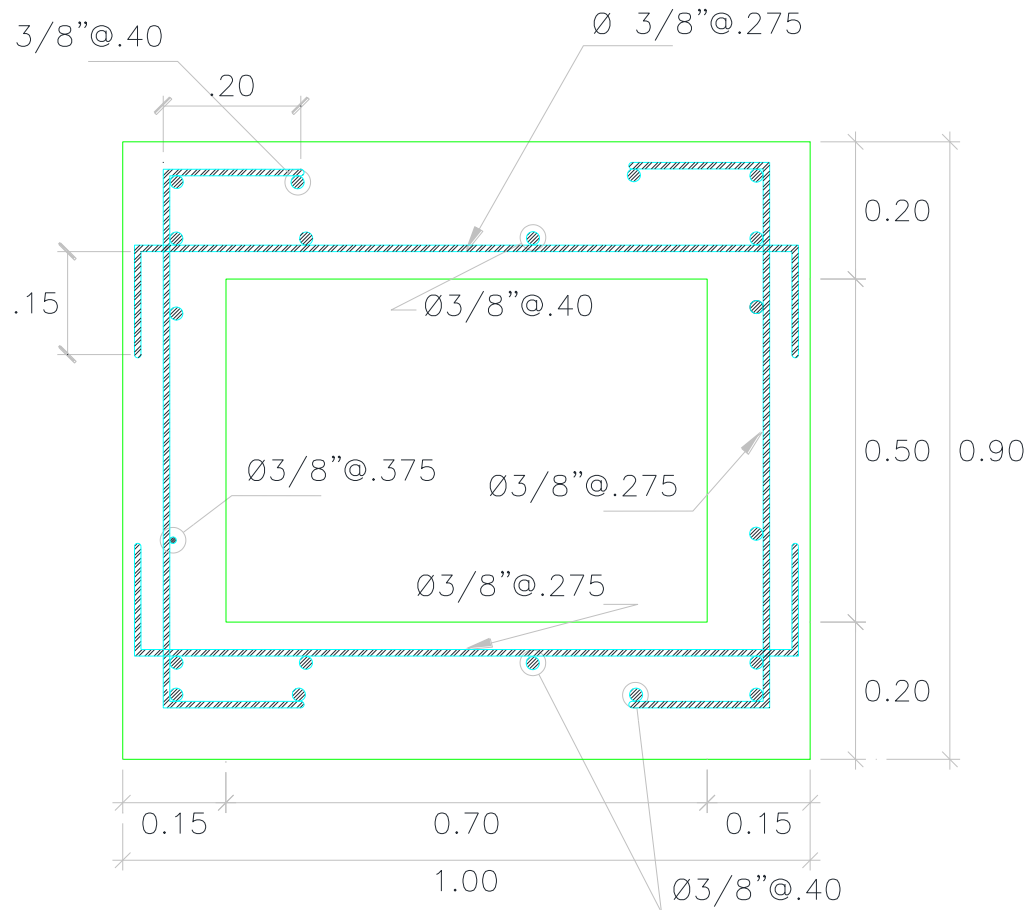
Disposición del acero en la alcantarilla. (Fuente: Elaboración propia)
